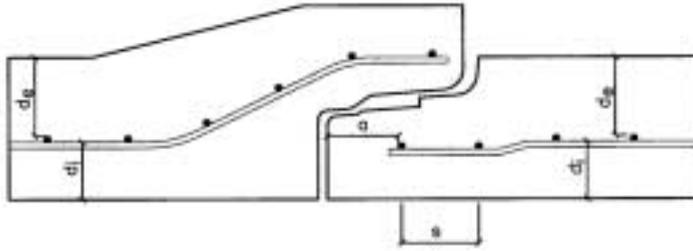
Recubrimientos y separaciones de las armaduras en los THA.
